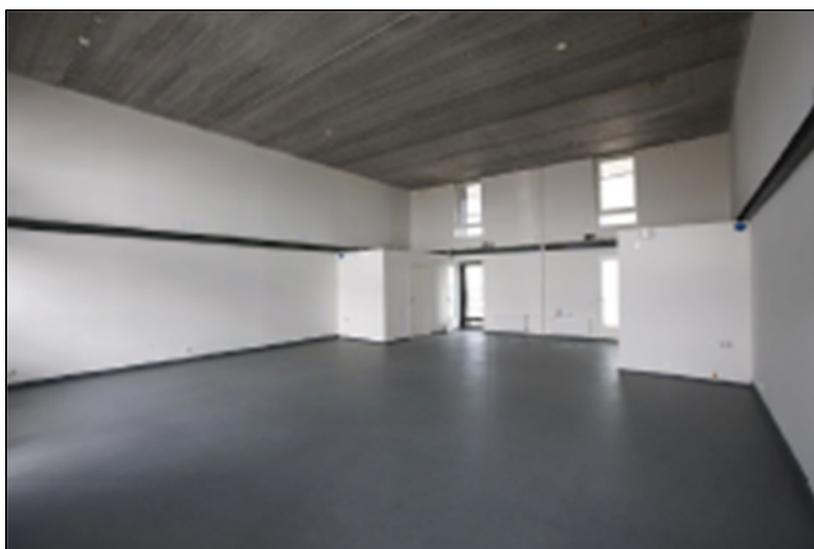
photographie intérieure de Tilla housing, source : *open-building.org
